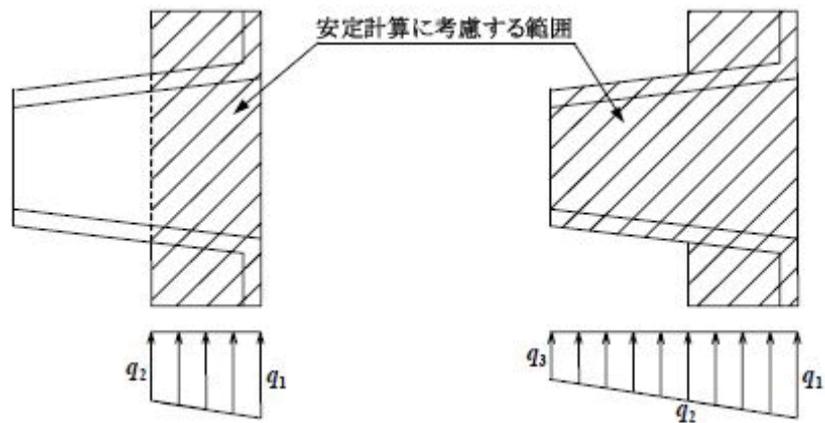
翼壁の安定に考慮する底版の範囲の考え方 (図 4.1.7-7 参照)
